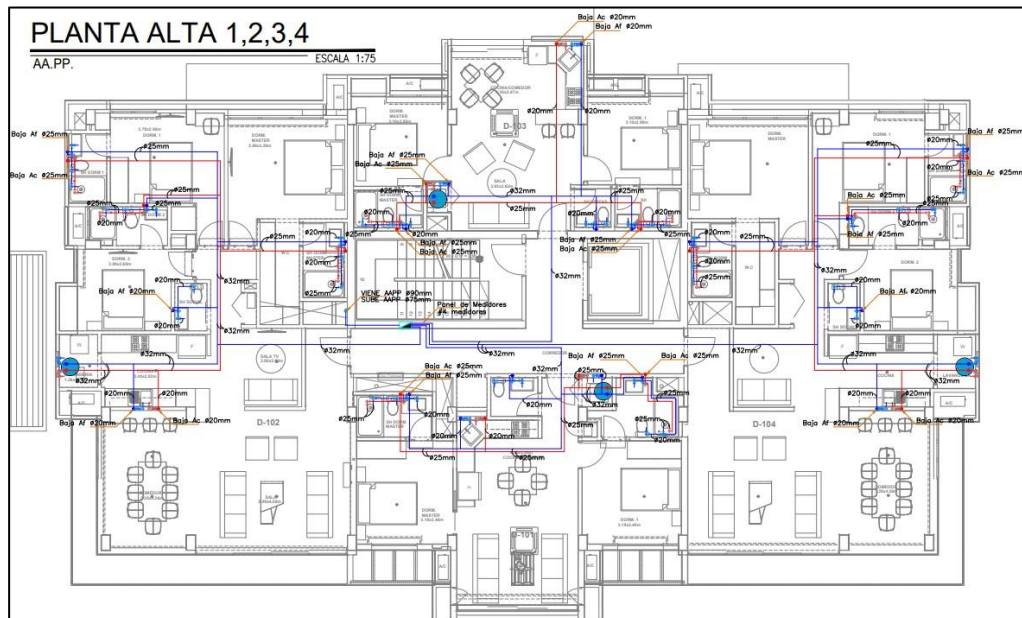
Plano de AAPP de Planta Alta 1,2,3,4
